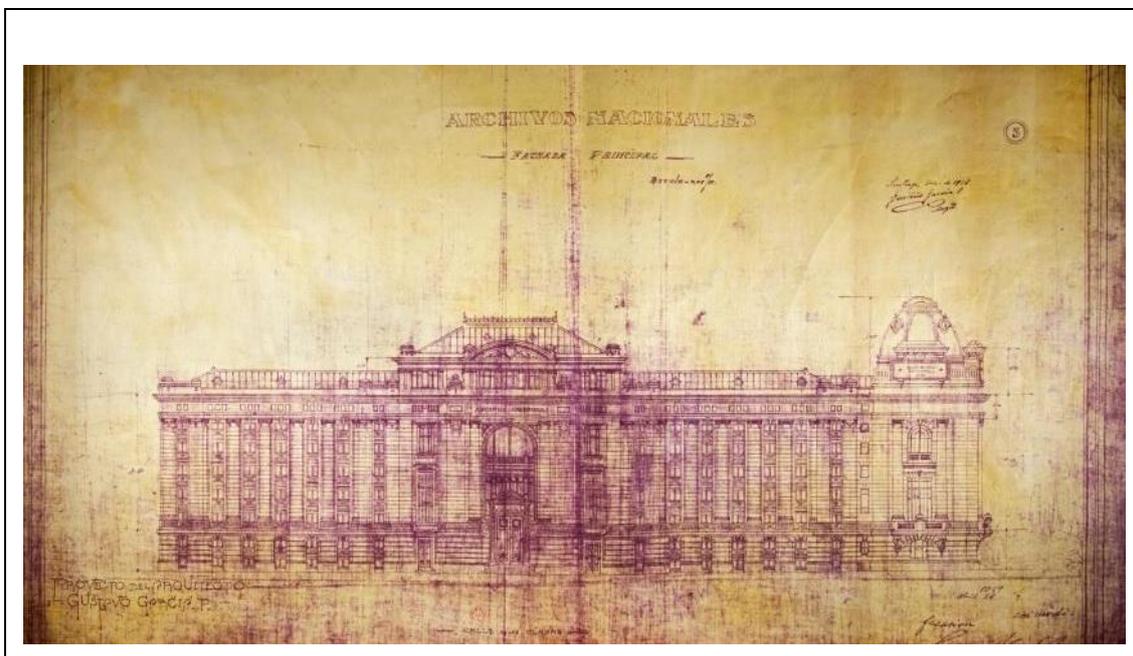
ELEVACIÓN DE LA FACHADA PONIENTE QUE ESTARÍA DESTINADA AL ARCHIVO NACIONAL Y QUE NO LLEGÓ A CONSTRUIRSE. COLECCIÓN ARCHIVO NACIONAL (ARCHIVO NACIONAL, S.F.-H)
